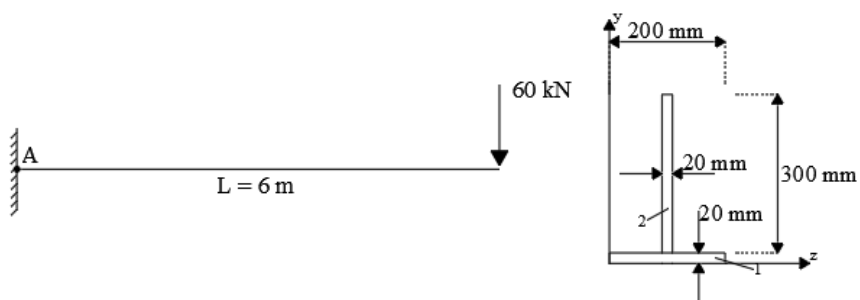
Viga engastada, submetida a carregamento pontual e com seção transversal em T invertido
